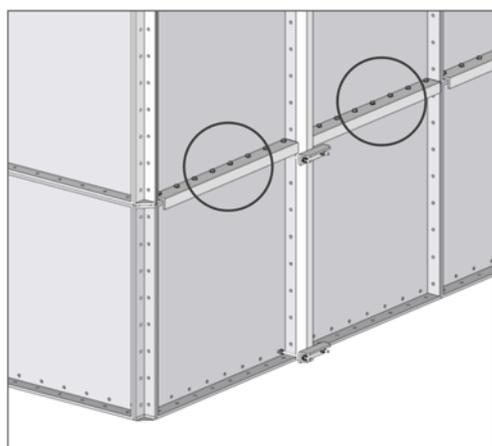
Detalhe da fixação das braçadeiras verticais de reforço
